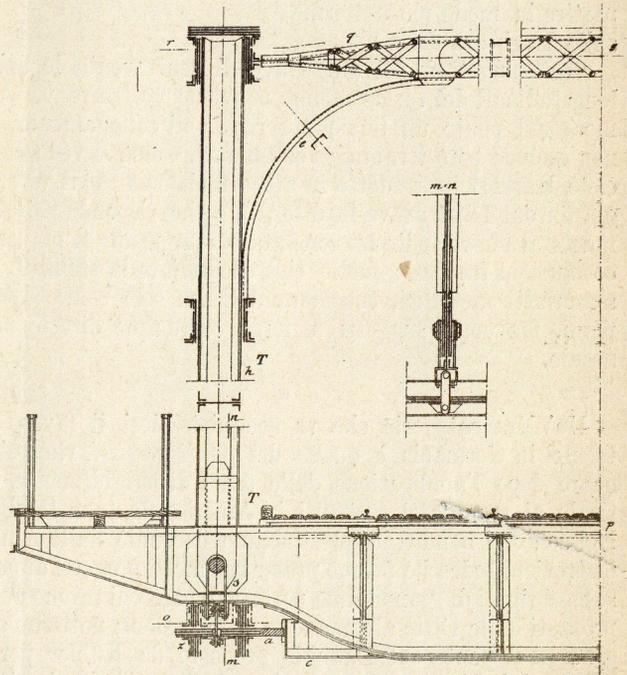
Mezza sezione trasversale del ponte sul Reno a Worms per ferrovia a doppio binario.
